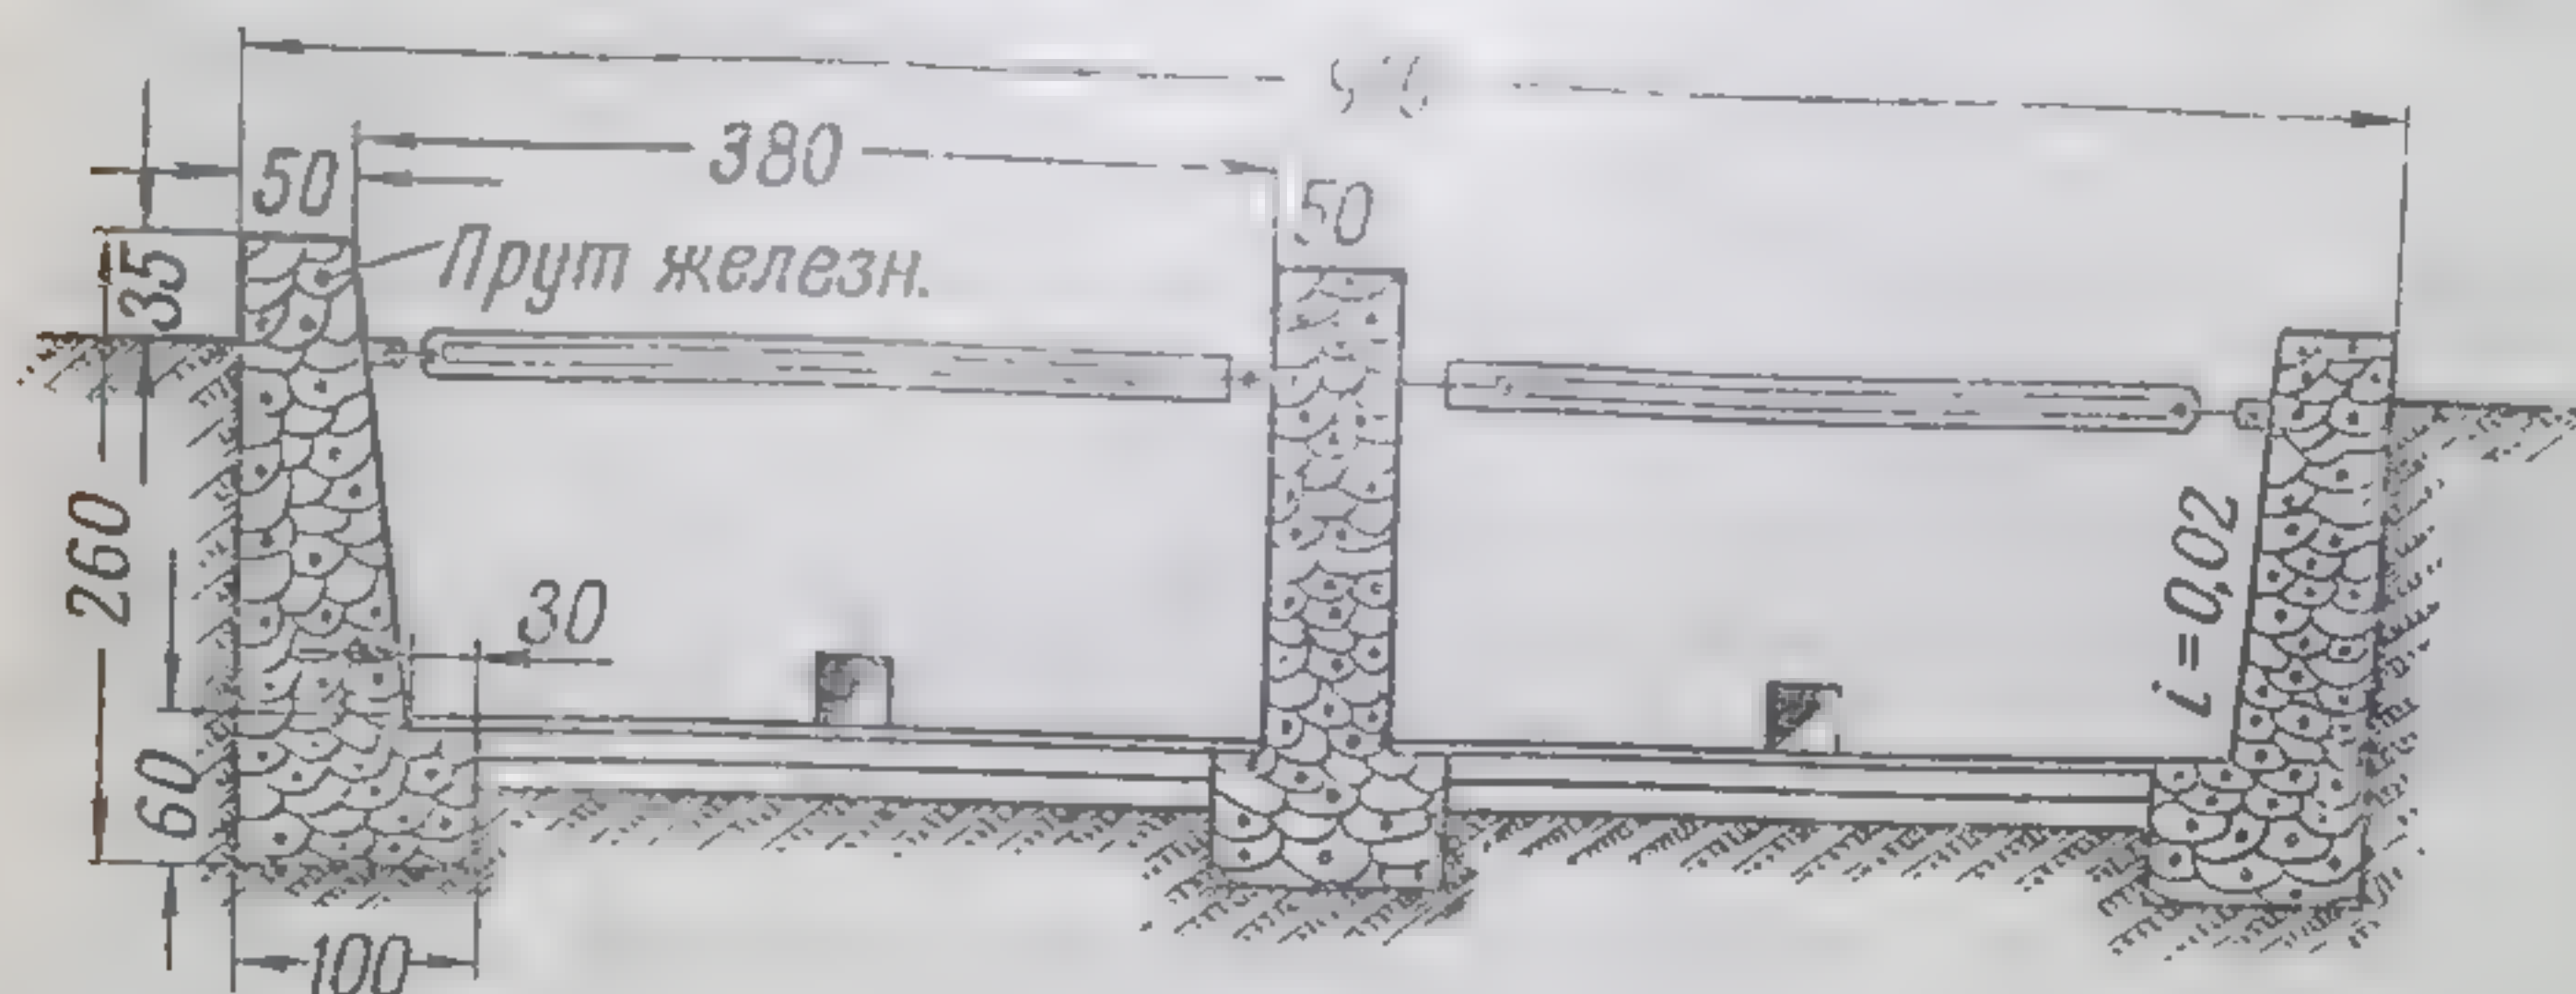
Спаренный мочильный водоем со стенами из бутового камня и укладкой прутowego железа (поперечный разрез).
